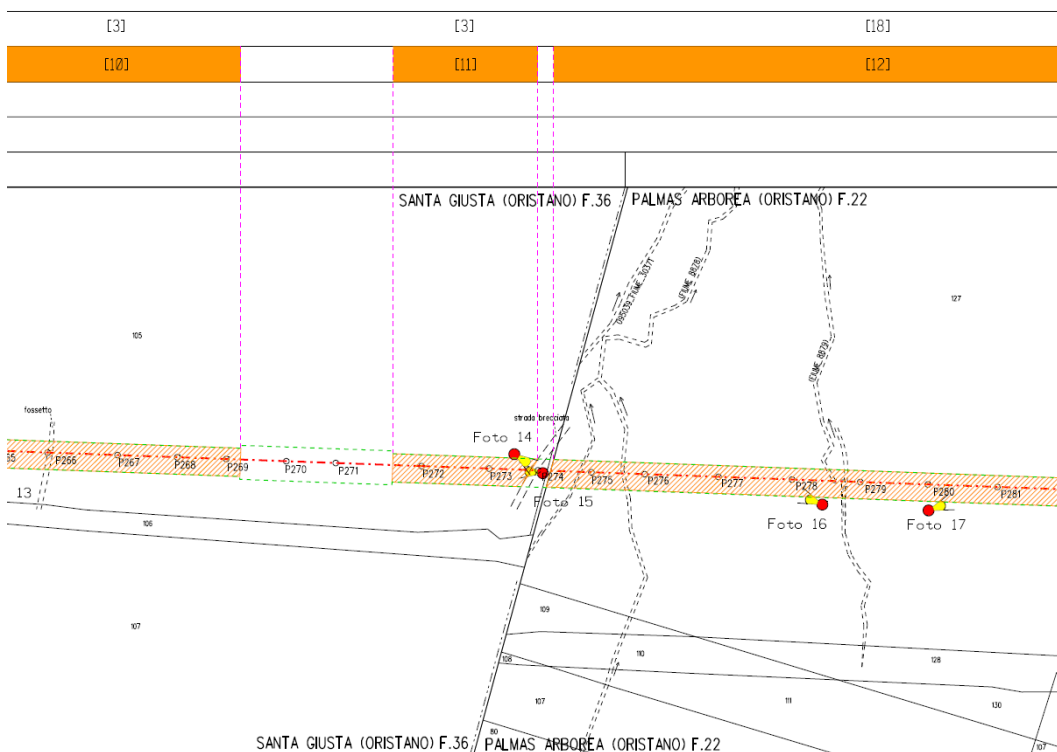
Tratto P271+40m – 273+30mt - la zona delimitata dalle linee verdi rappresenta la fascia ristretta di lavoro per come previsto dalla GASD C 13.40.10.02
